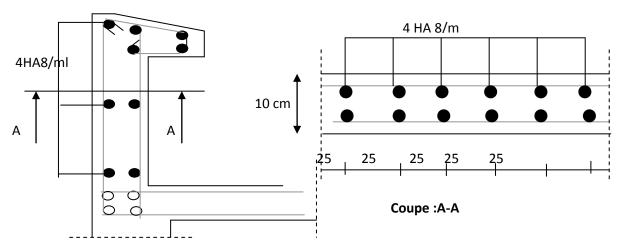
Schéma du ferraillage et coffrage de l'acrotère
